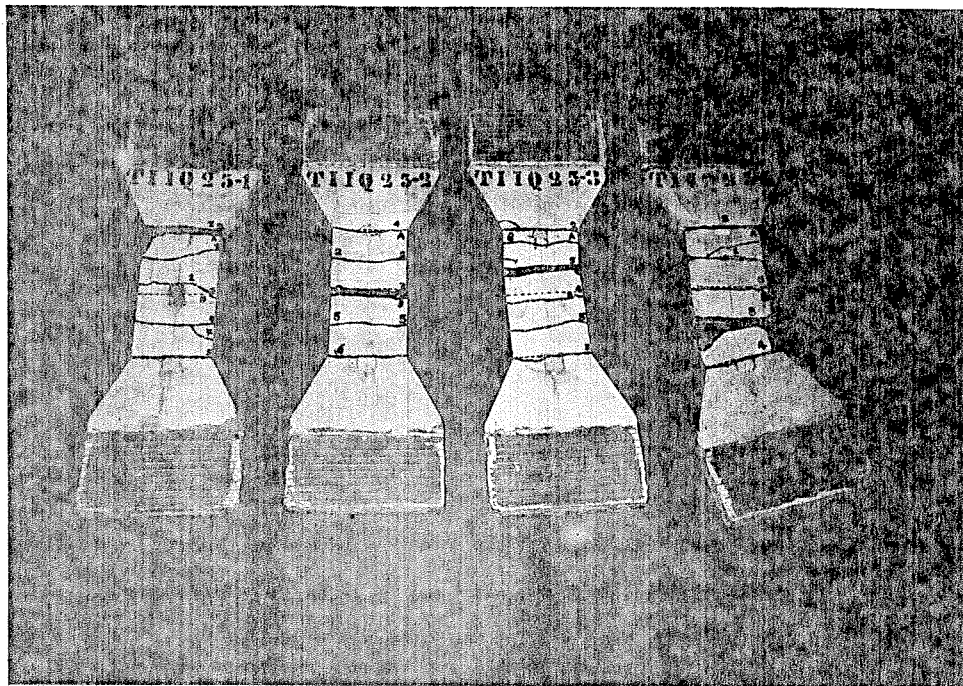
Fissuração final - Série TI1025 (face 1 - regiões A e B)
